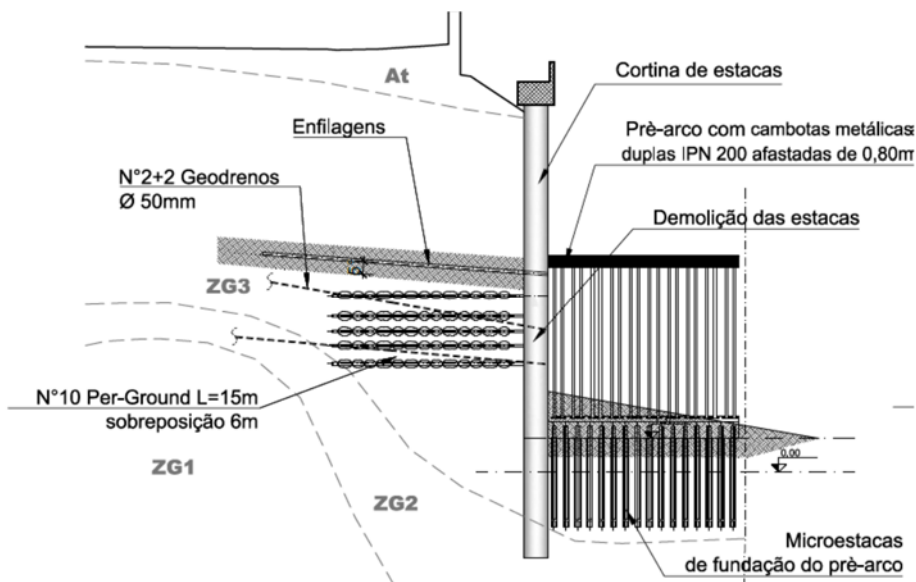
Secção tipo do falso túnel no emboquilhamento nascente
